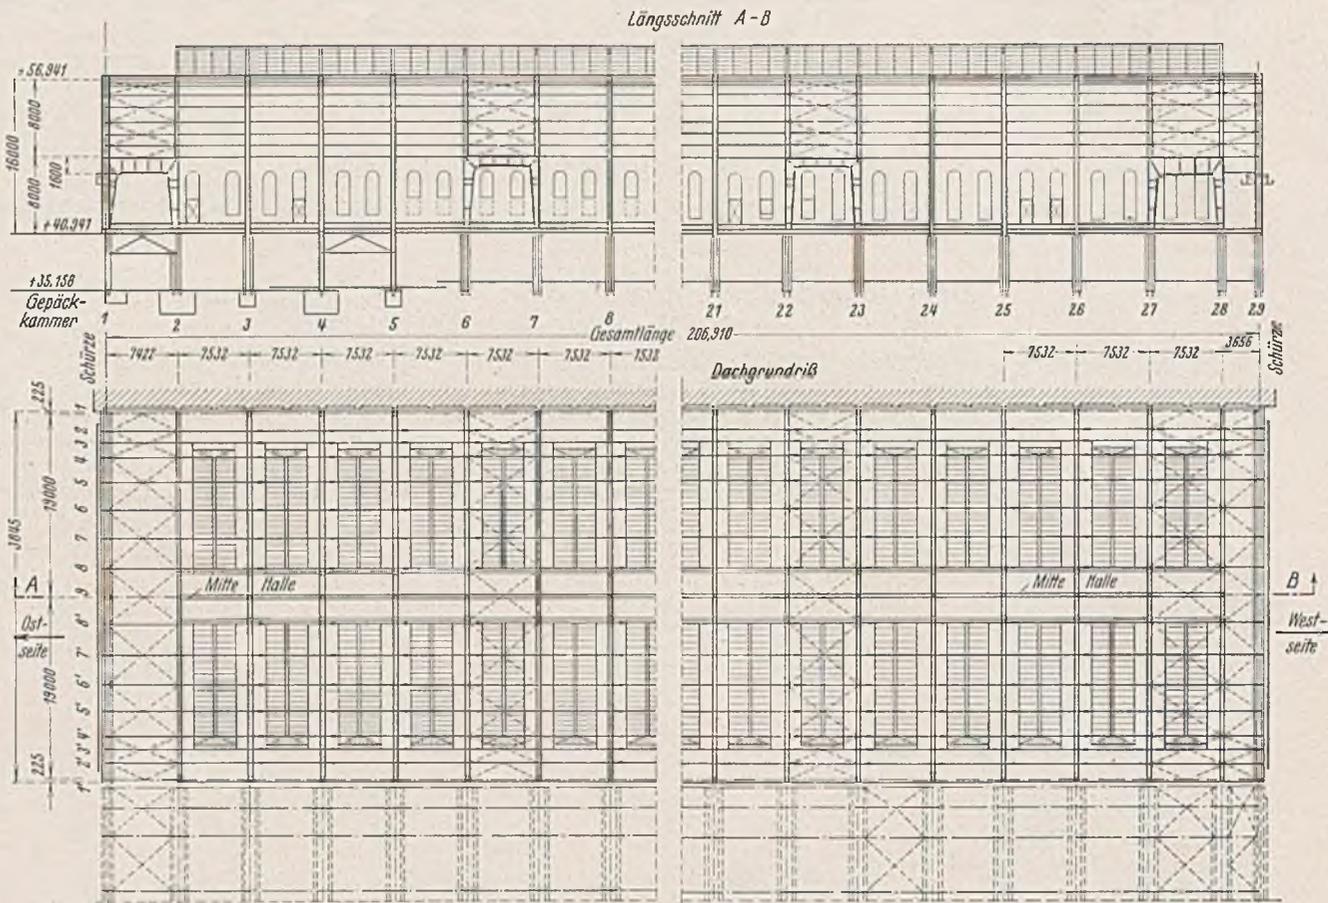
Übersicht, Längsschnitt und Grundriß der neuen Südhalle.
